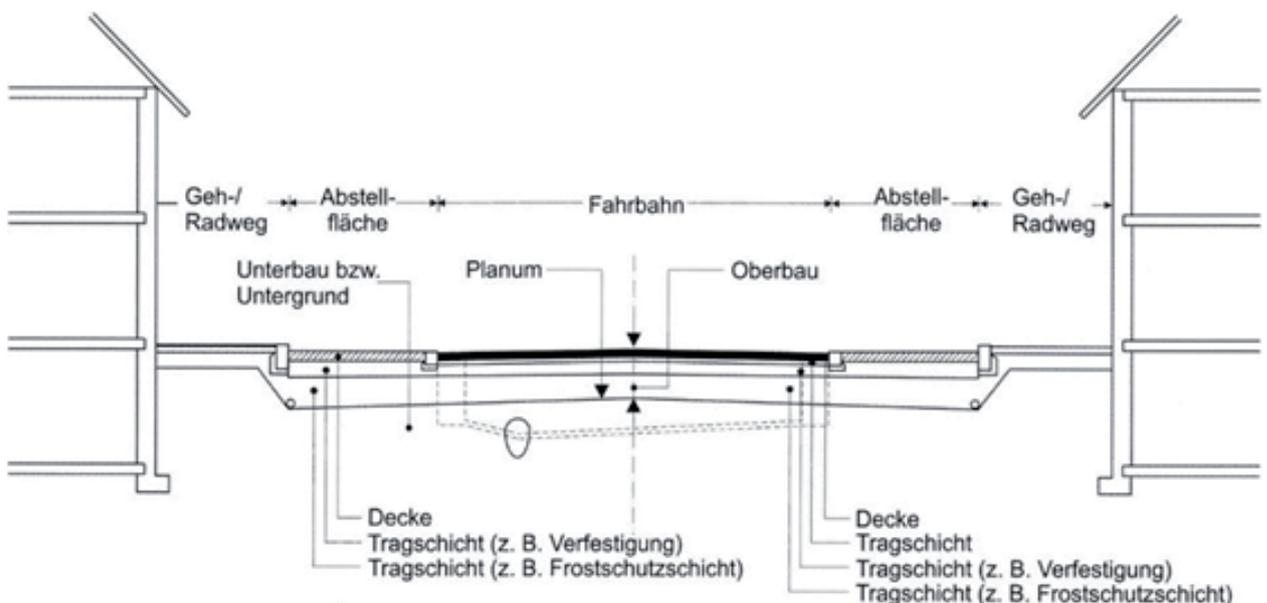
Beispielhafter Aufbau einer Befestigung in geschlossener Ortslage mit wasserundurchlässigen Randbereichen und geschlossener seitlicher Bebauung sowie mit Entwässerungseinrichtungen
